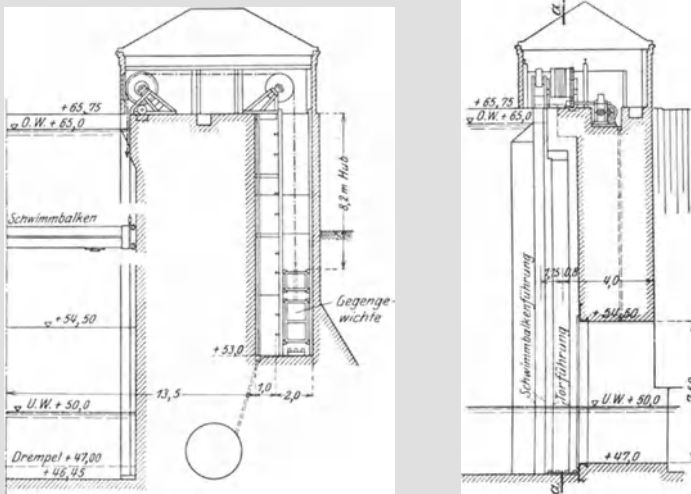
Tor- und Schwimmbalkenaufhängung der Schleuse Anderten. Maßstab 1 : 400.
